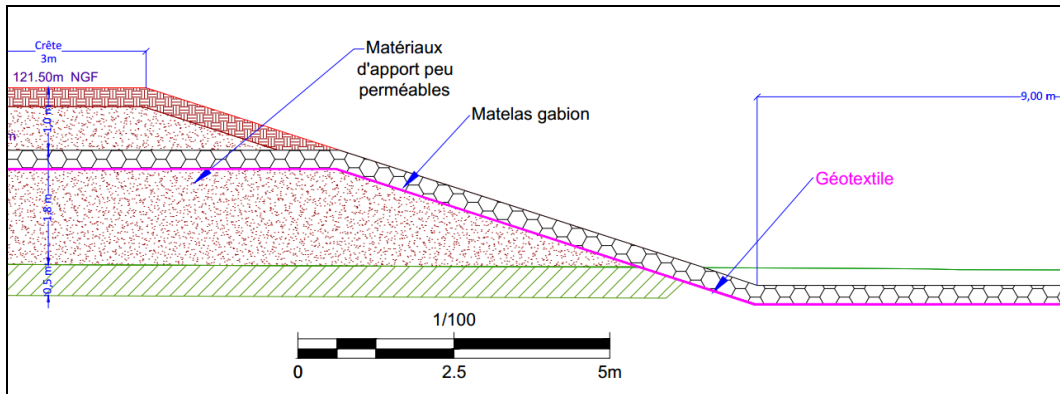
Ouvrage D19-8 - Coupe en travers du corps de l'ouvrage (parement aval)
